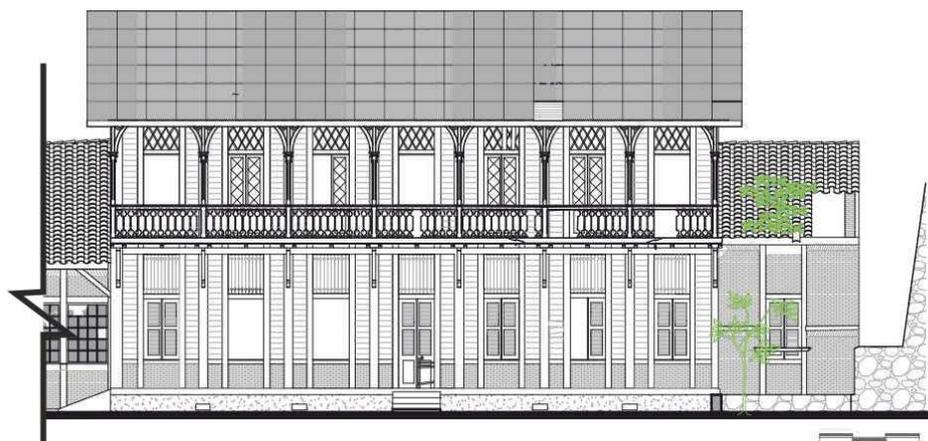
Fachada SE da casa-de-máquinas e telhas.
